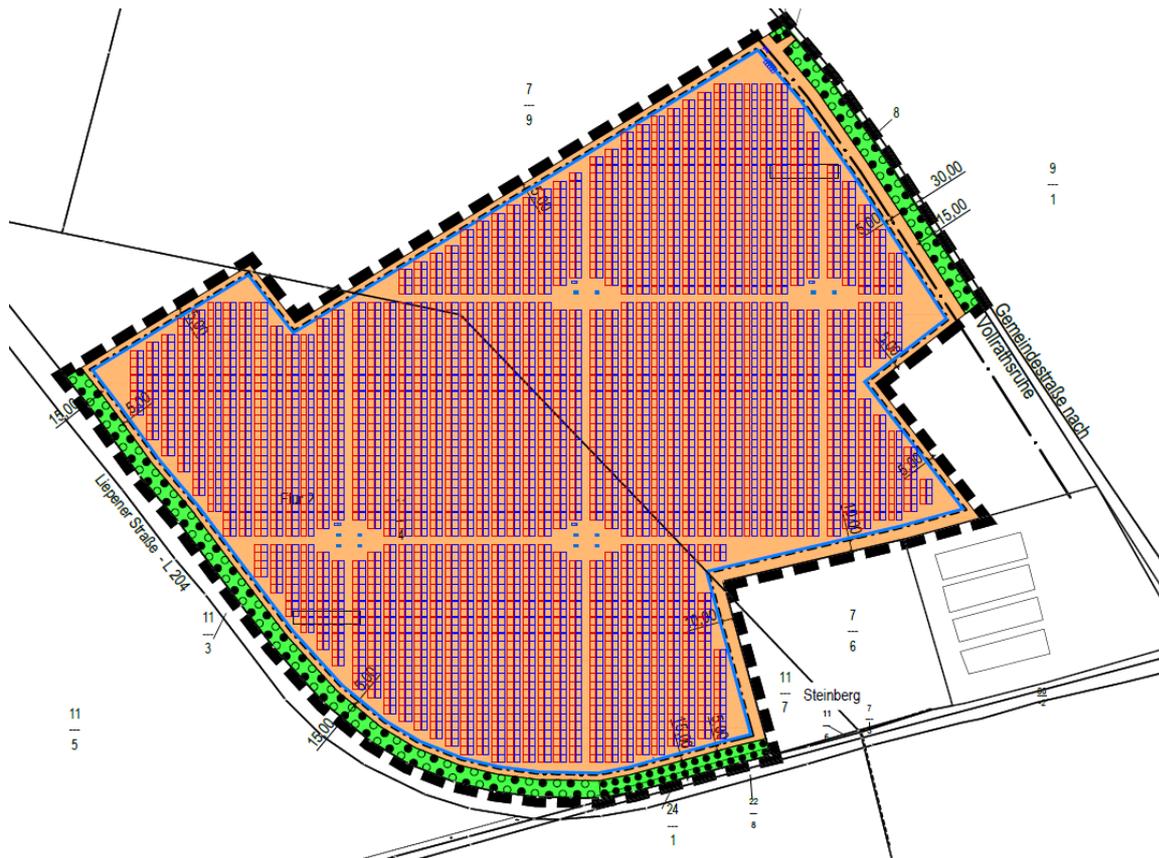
Auszug aus dem Bebauungsplanentwurf (STADTRAUMPLAN 2025) überlagert mit dem Belegungsplans von WI Energy (2025)
